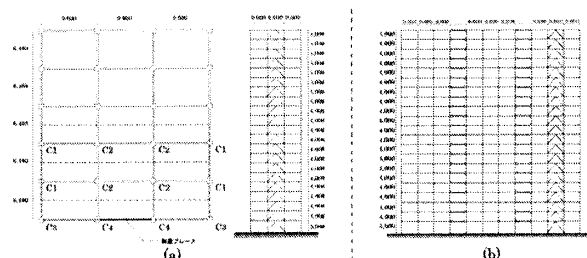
(a) 平面・立面図, (b) 擬似立体解析モデル
